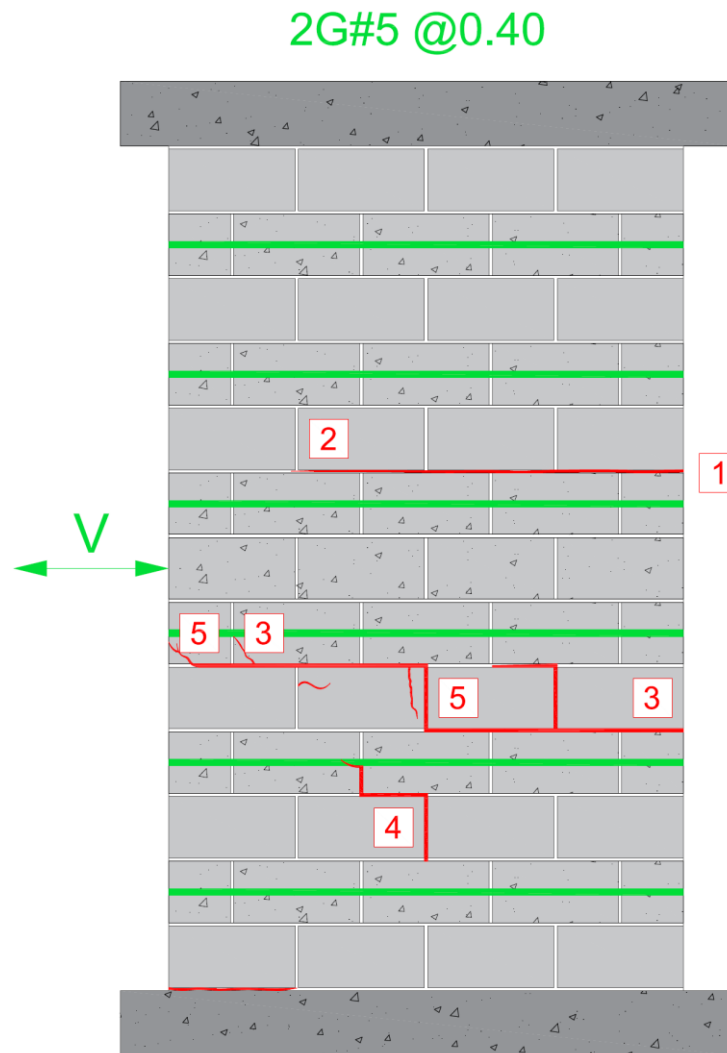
Fisuración y modo de falla del muro MC-2#5/40
